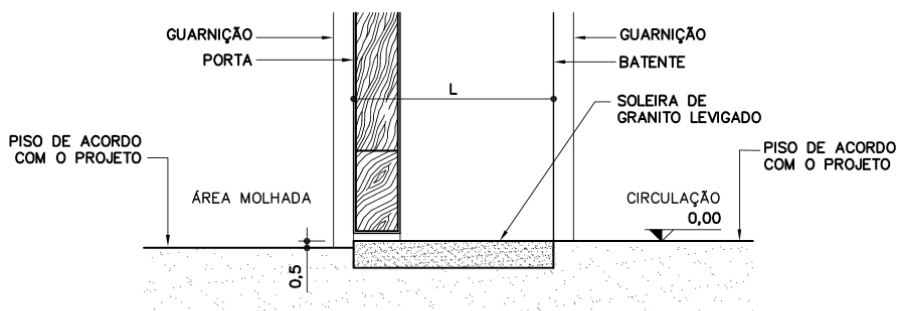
Planta e Vista Padrão Soleira (fonte FDE)
